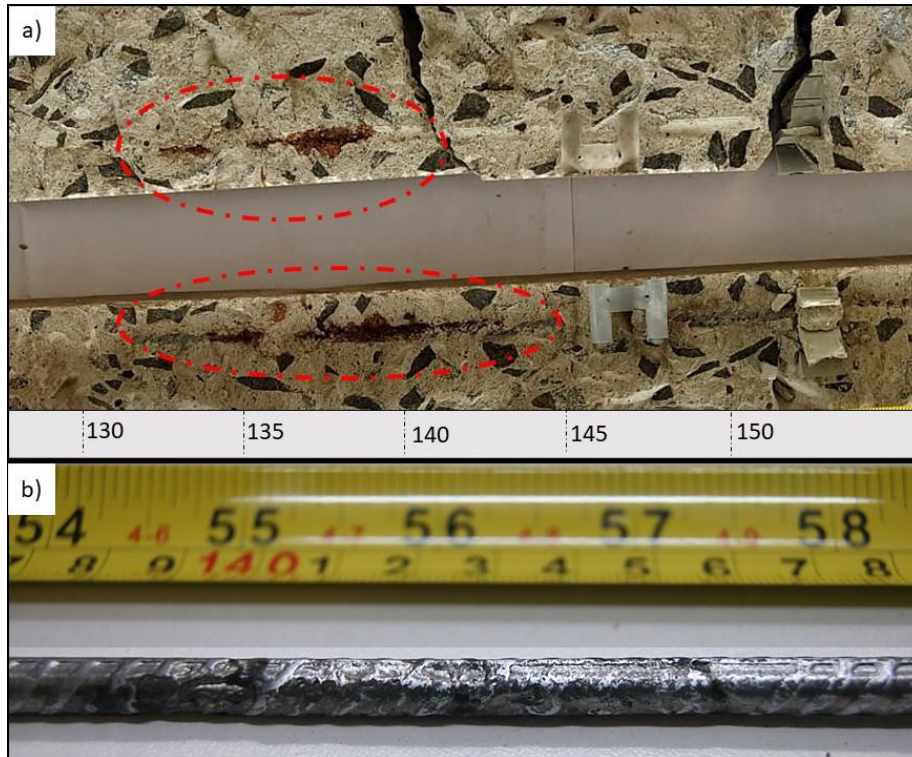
Produto da corrosão na vc 3 c/c no local que surgiu a fissura longitudinal, sendo: a) viga aberta; b) armadura.
